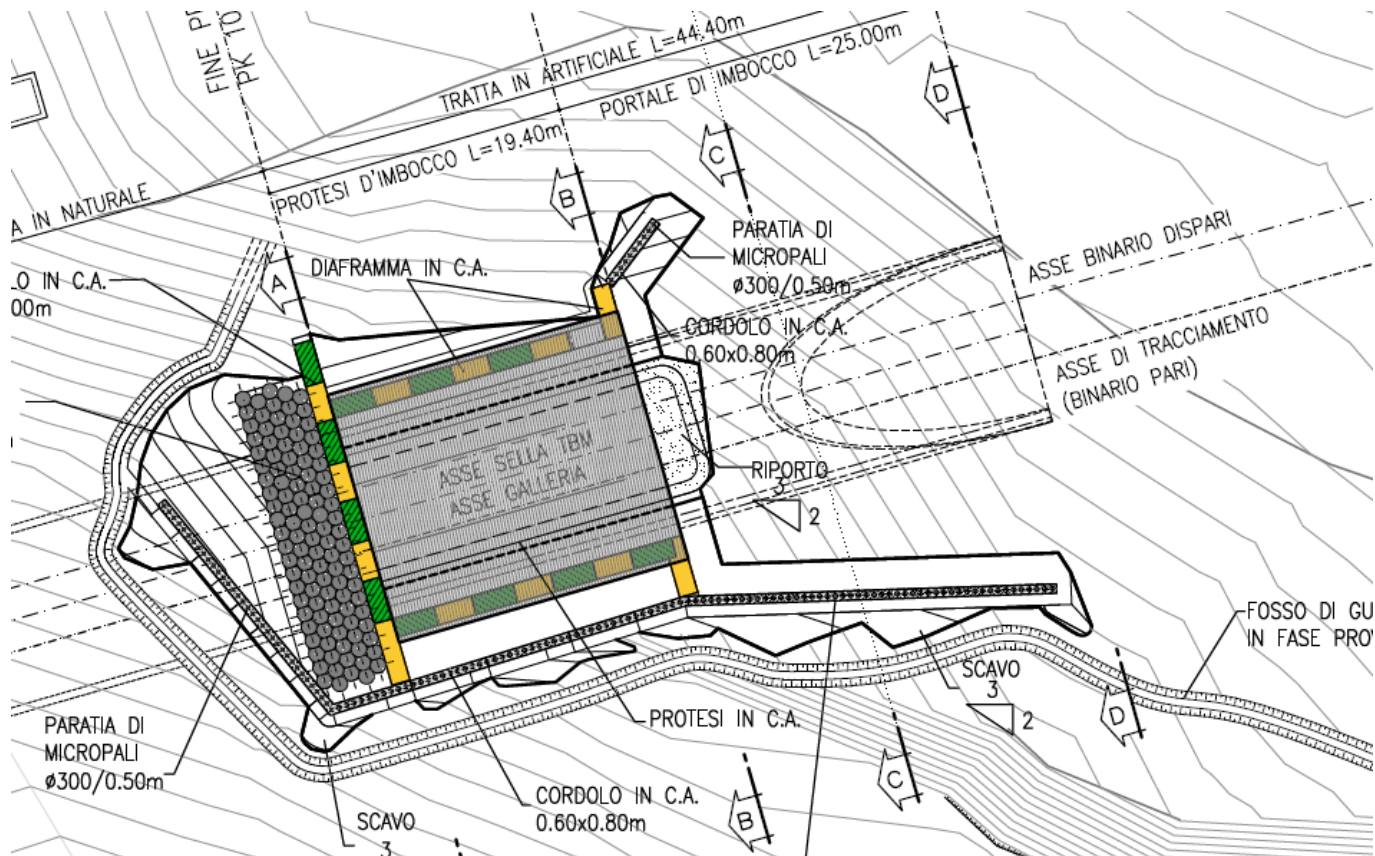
Selle per traslazione TBM – Imbocco lato Bari – Planimetria
